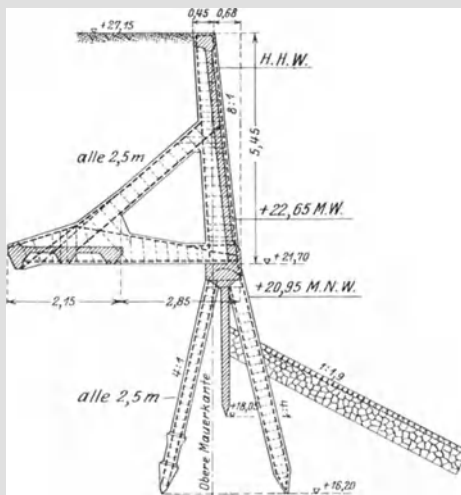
Ufermauer im Hafen Schweglern aus Eisenbeton. Maßstab 1 : 180.
